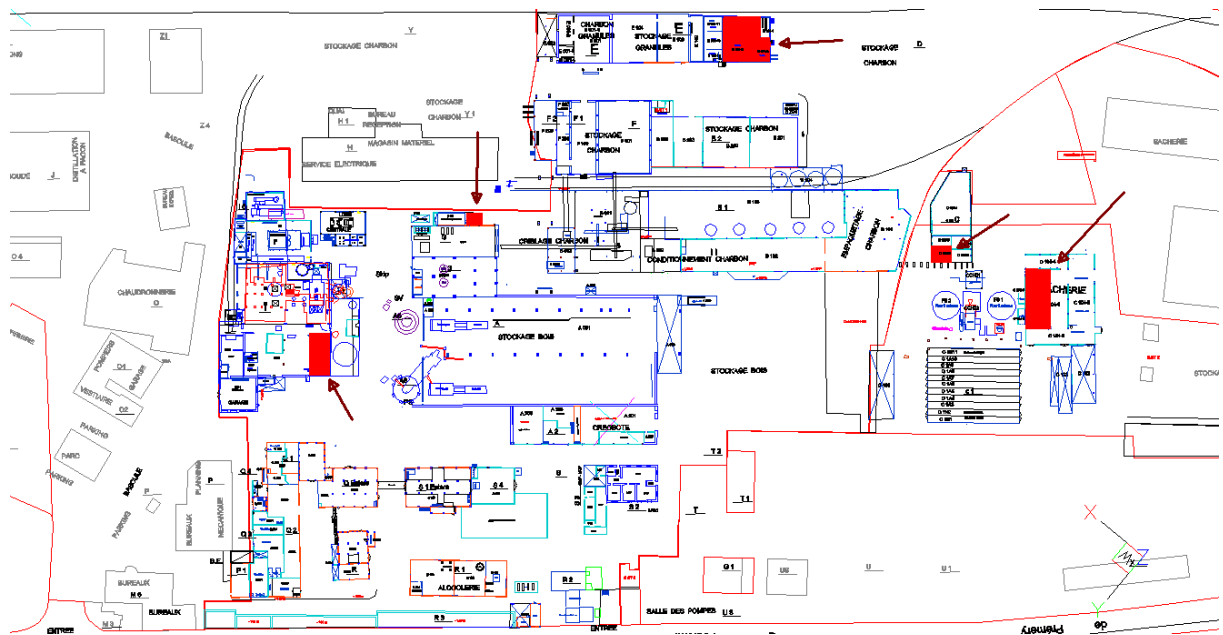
principaux Plafonds et faux plafonds fibre-amiante
